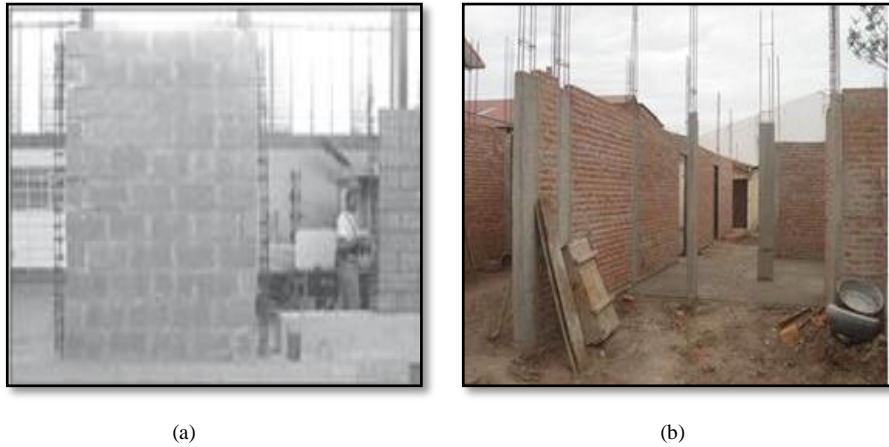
Esquema general de construcción de mampostería confinada. a) Pared de bloque de concreto b) Paredes de ladrillo. Confinadas con columnas de concreto.
